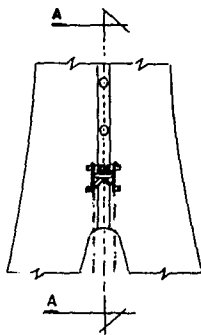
Desviadores superiores e inferiores de los cables guía.
